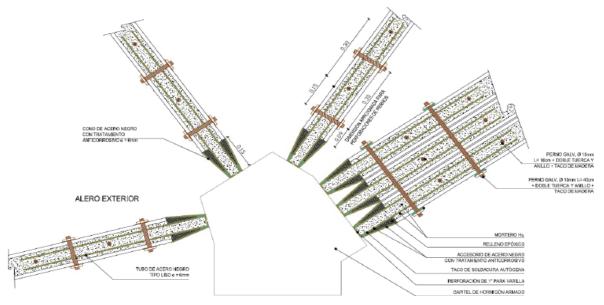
Detalle constructivo de bambú con anclaje metálico
